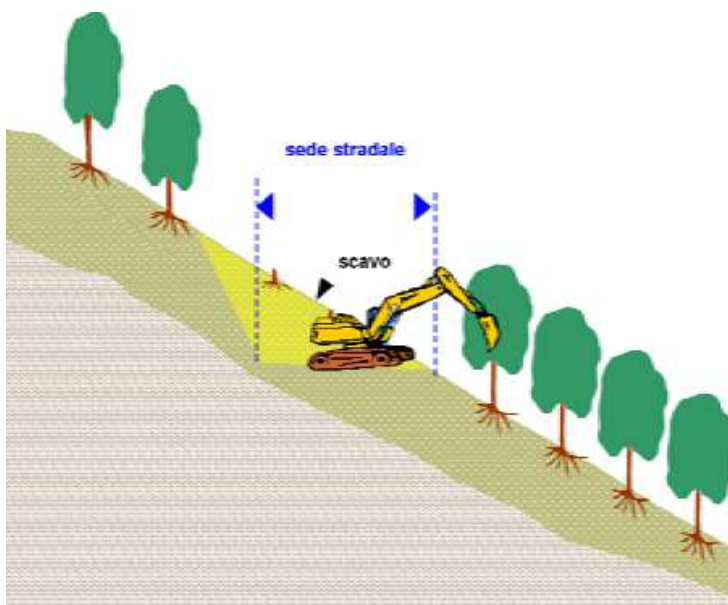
Schema di realizzazione pista di cantiere Tipo II - Scavo.
